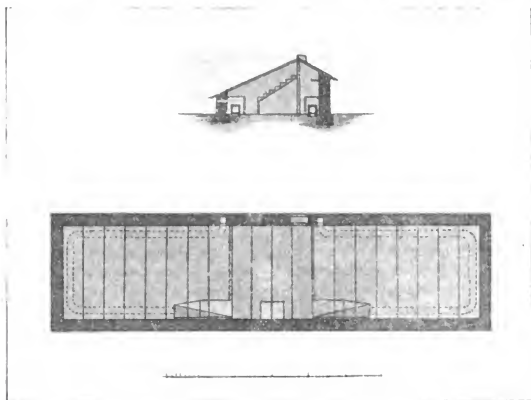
Fig. I. Schnitt und Grundriss einer Treibhausanlage für Garten-Liebhaber.
